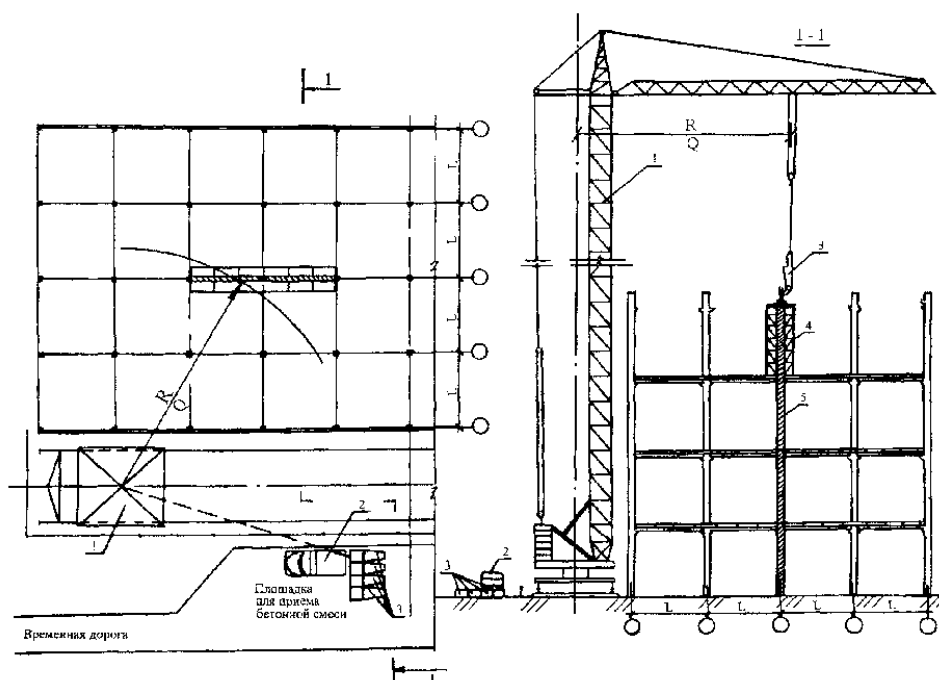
Схема бетонирования стен: 1 - башенный кран; 2 - автобетоновоз; 3 – бадья для приема бетонной смеси; 4 - опалубка с подмостями; 5 - забетонированная стена
